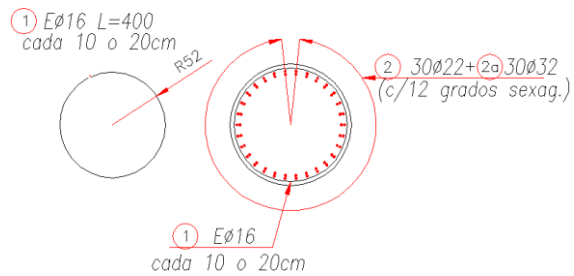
Detalle estribo y sección pilotes cepa A en mm.
